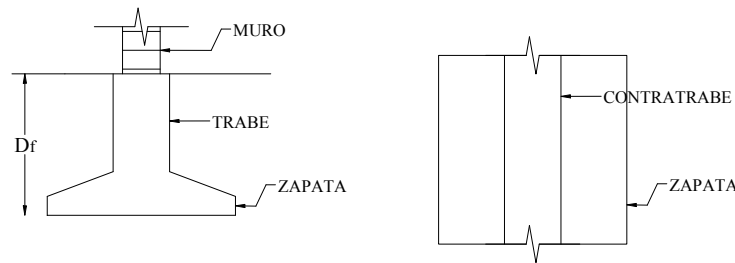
Planta y perfil de zapatas corridas, (Rivera Constantino).
